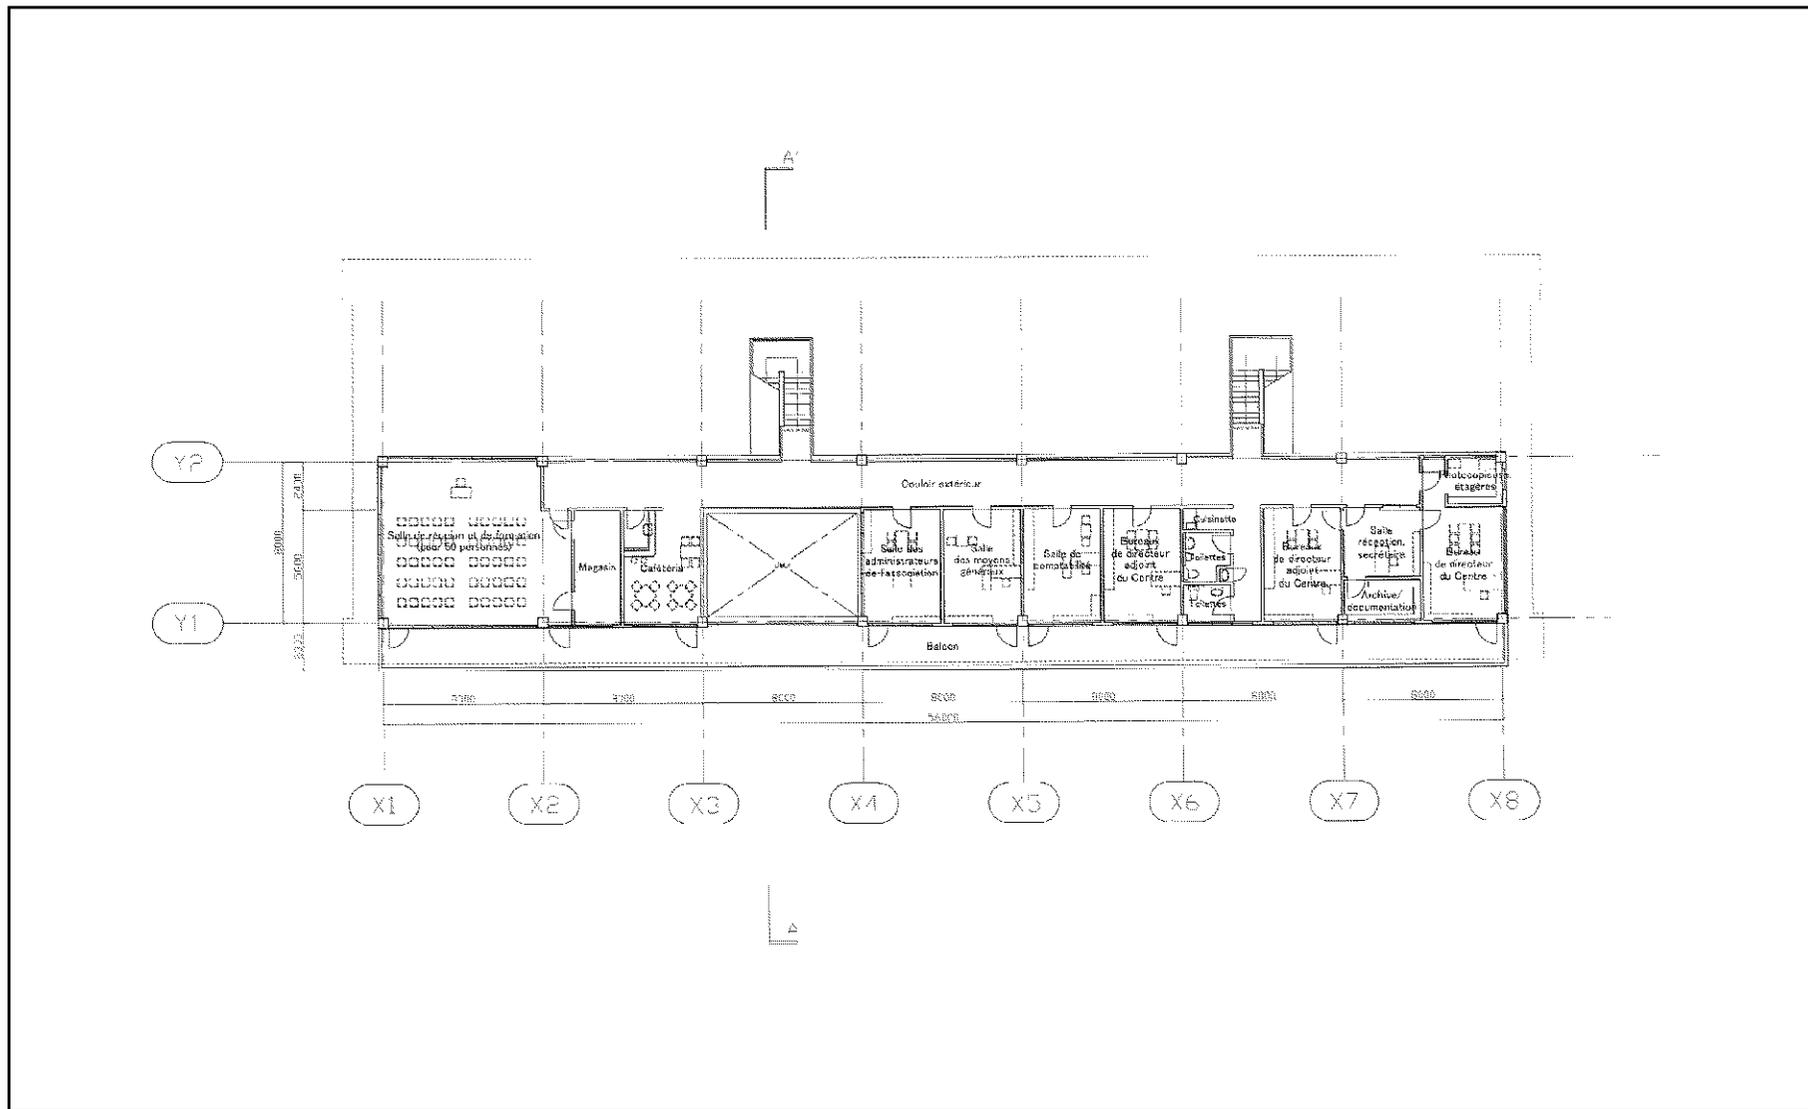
(53) Vue en plan du 1<sup>er</sup> étage
